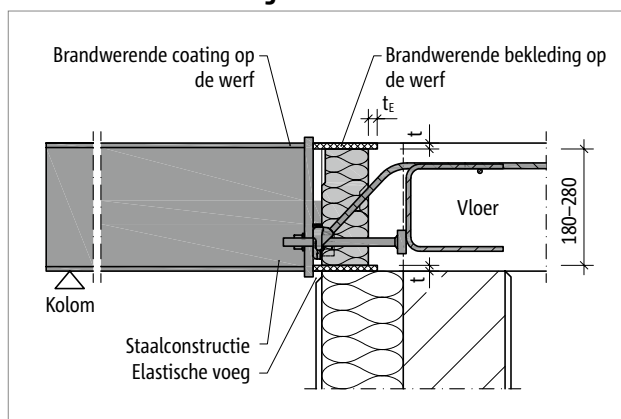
Schöck Isokorb® T type SQ-V3: Doorsnede
